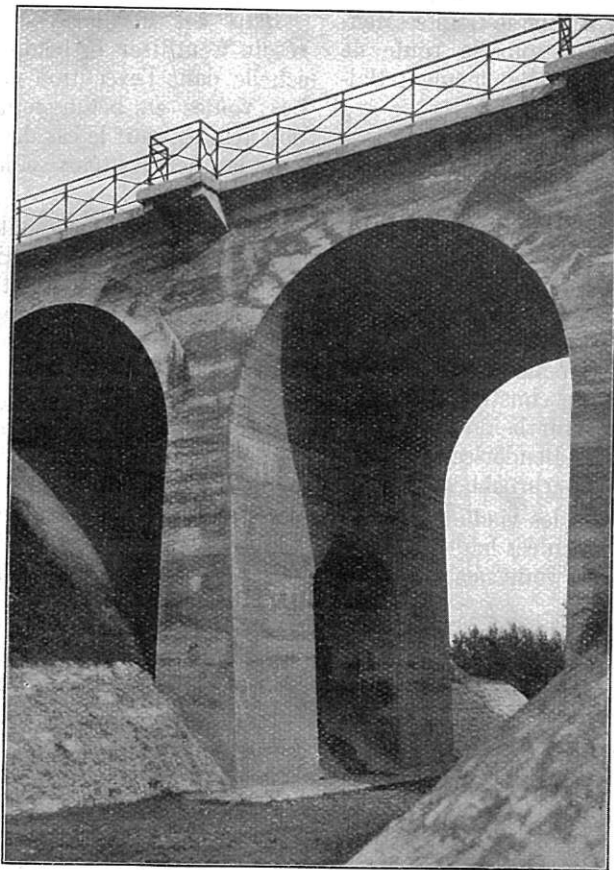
Ligne de Bruxelles (Midi) à Gand-St-Pierre. Ouvrage sur le « Molenbeek ».
